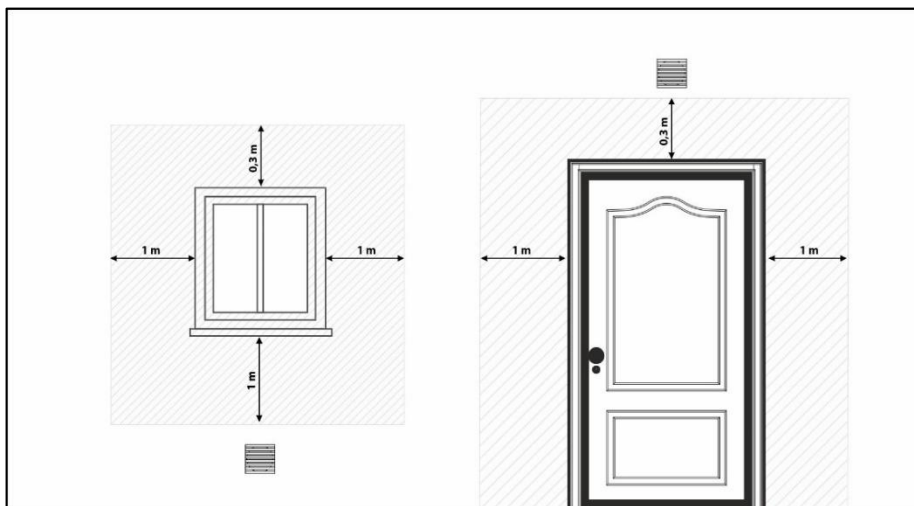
Distanțele minime pentru montarea grilei de ventilație
